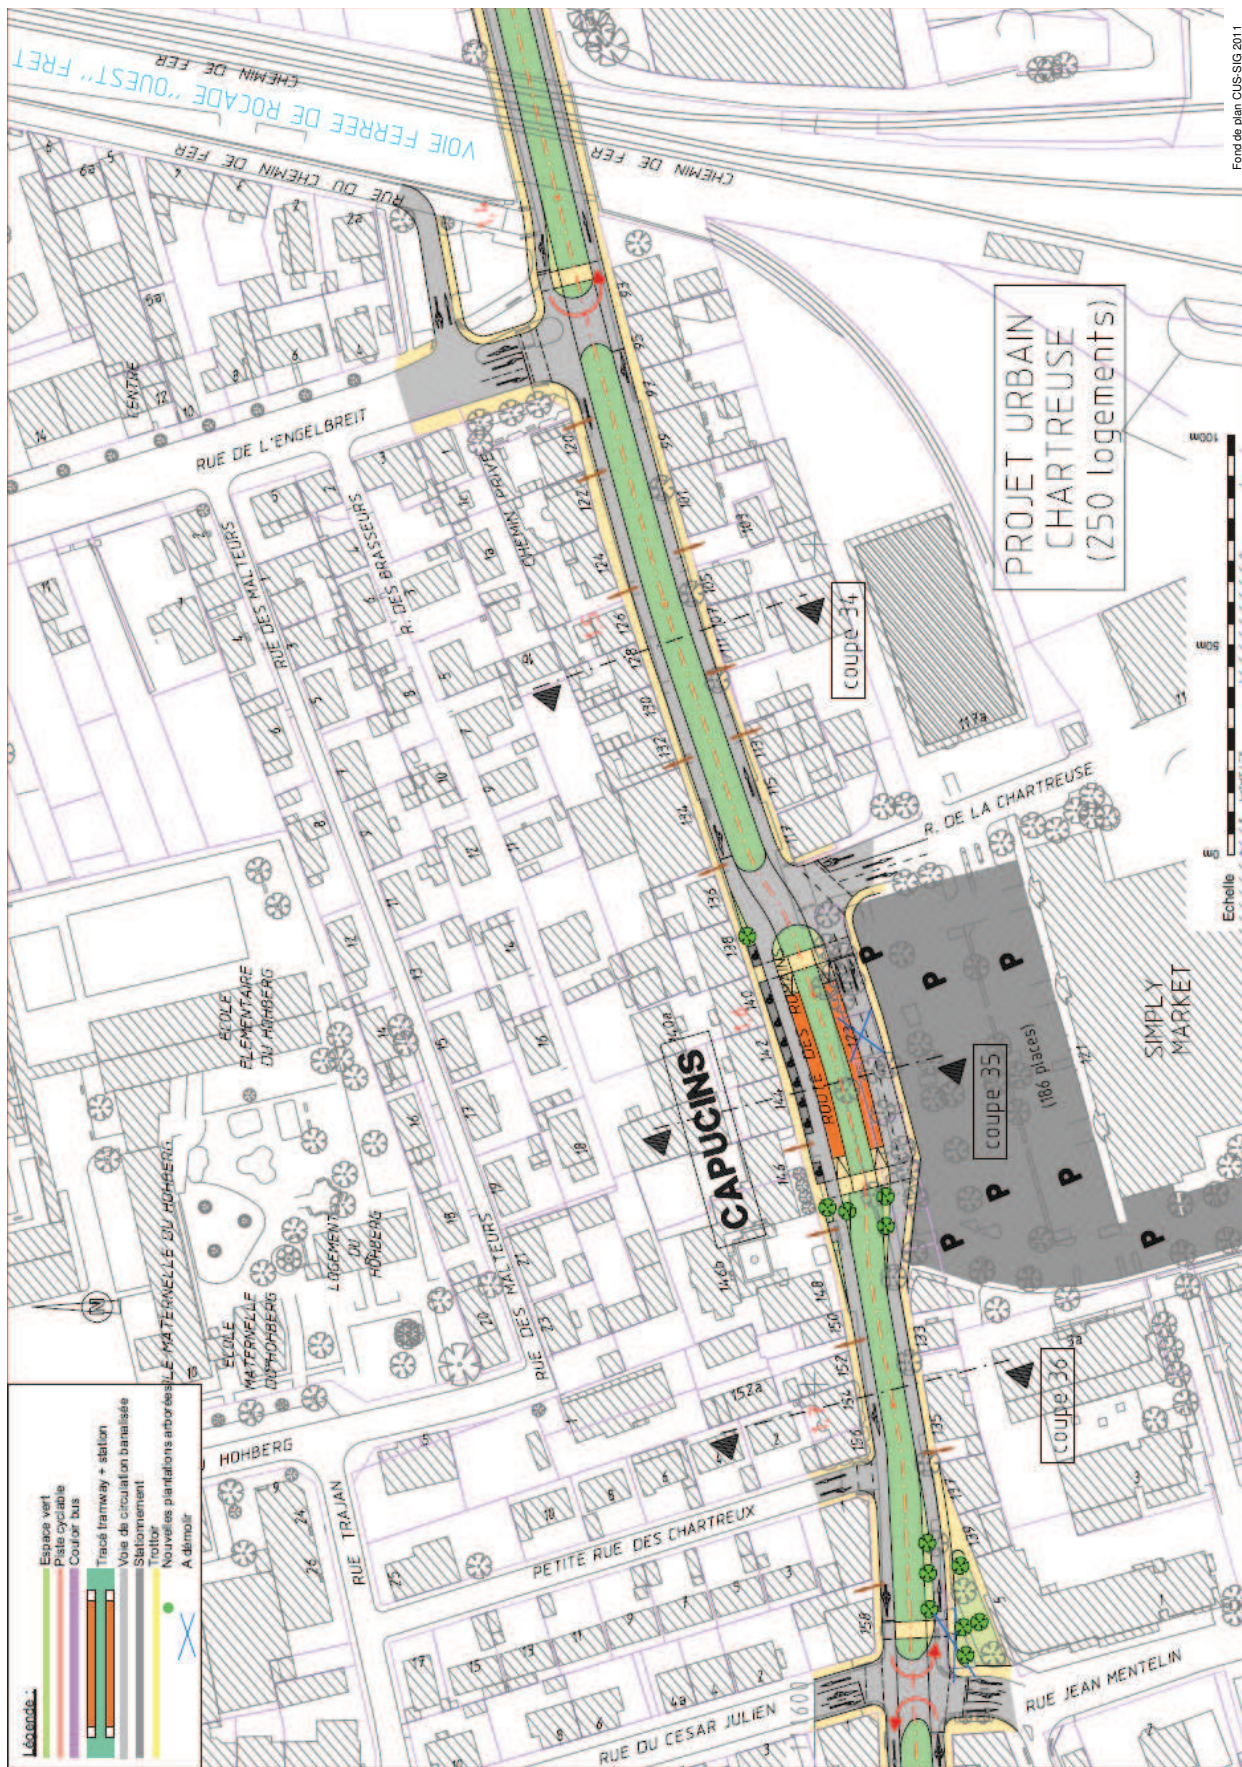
Plan zoom sur secteur "Engelbreit / Capucins"
